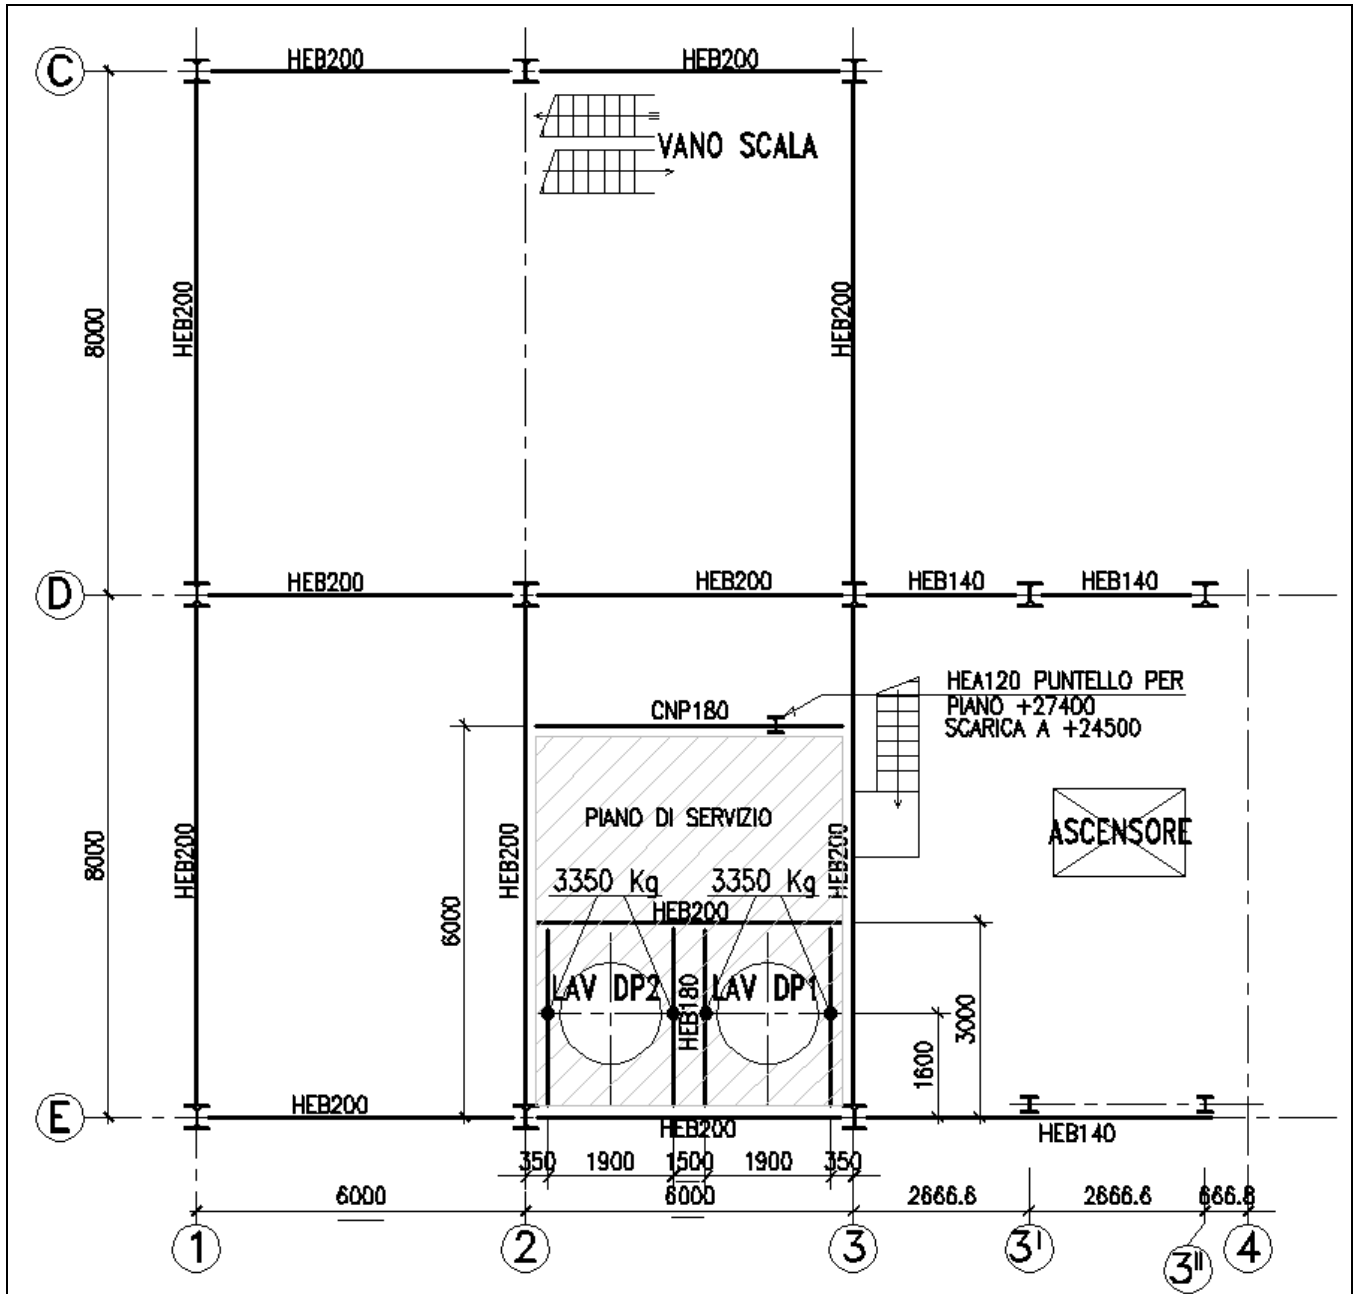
PLANIMETRIA +27.400 - quinto impalcato -
